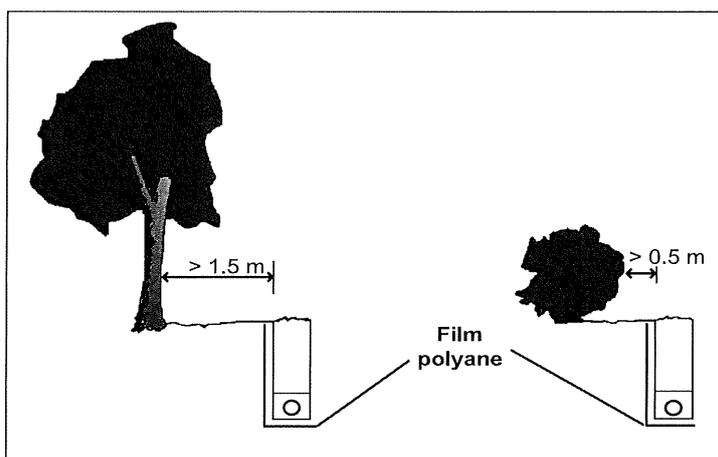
Implantation d'un réseau à proximité d'un arbre avec des dispositifs de protection
